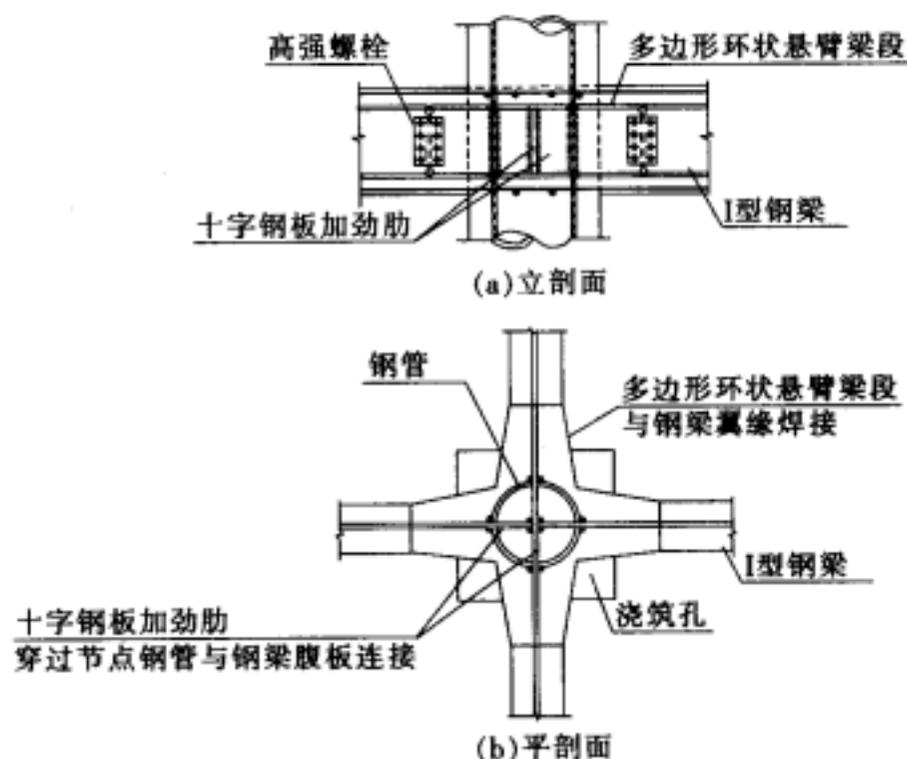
四根钢骨混凝土梁与钢管混凝土叠合柱连接节点
